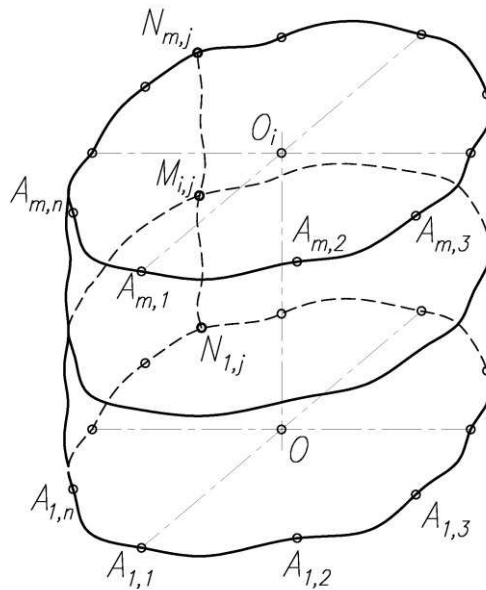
Геометрическая схема поверхности резервуара с несовершенствами.
